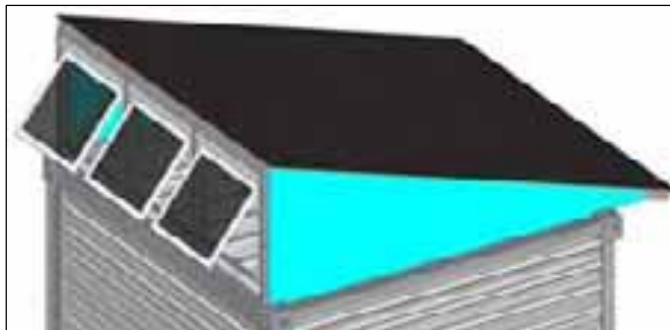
Vista cubierta escaleras con ventanas pvc y manto asfáltico. Fuente y Diseño: Hernández, G.
